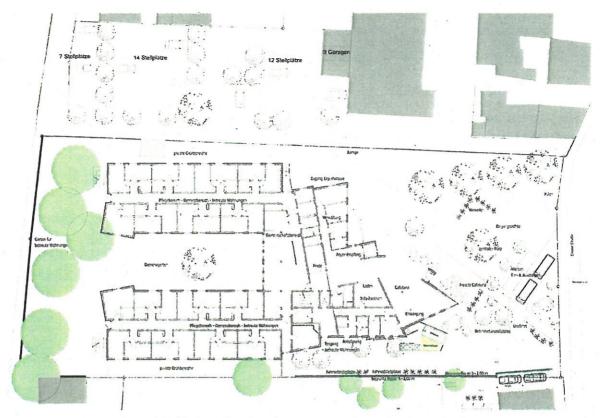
Lageplan Rumpf Architekten, August 2008
